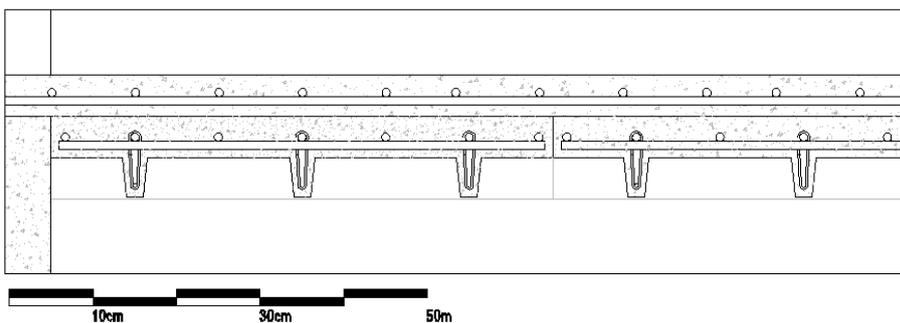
Panel de entrapiso con la capa de compresión de hormigón posterior.
